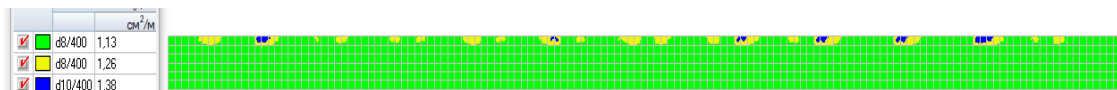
Армирование монолитных стен нижняя по x (комбинация нагрузок С1)
